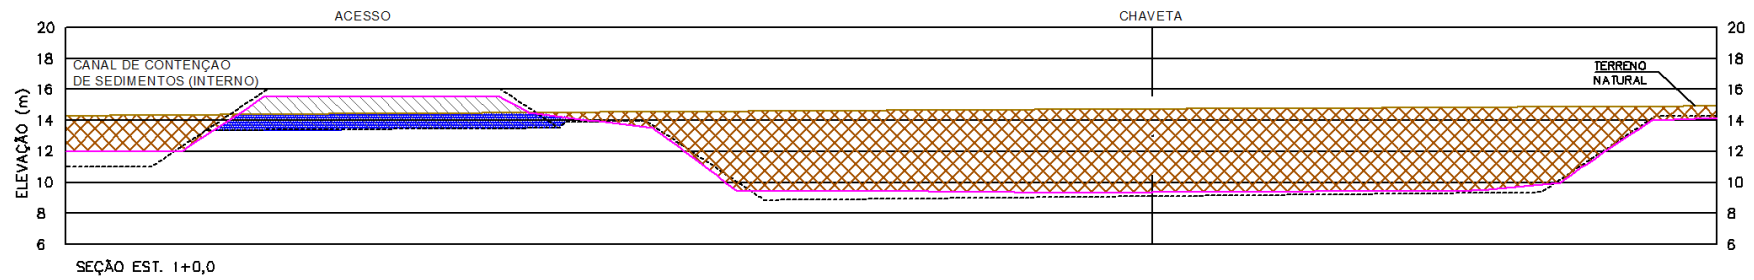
Detalhe da escavação da chaveta contornando o DRS2 (PIMENTA DE AVILA, 2018)
